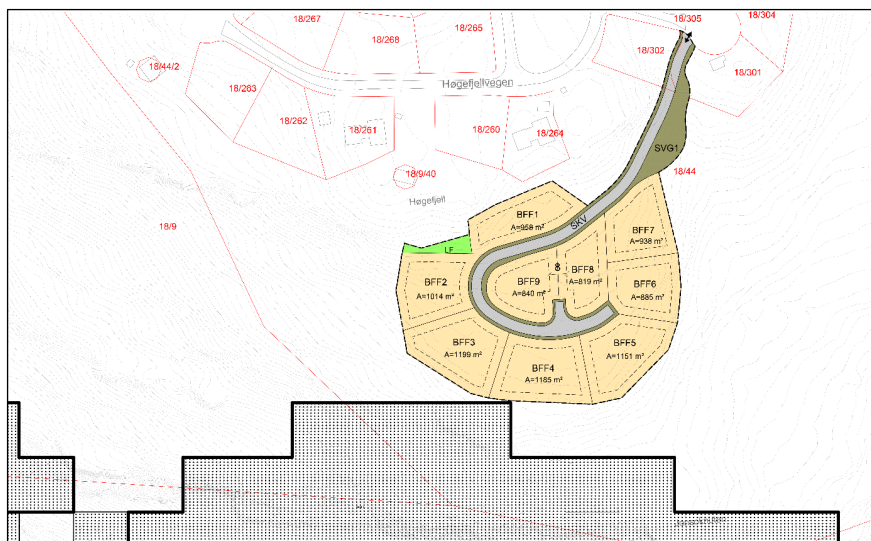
Areal avsatt til trafo i tilgrenset plan for deler av H4 ved Høgefjell (planID 04_53_2014).
